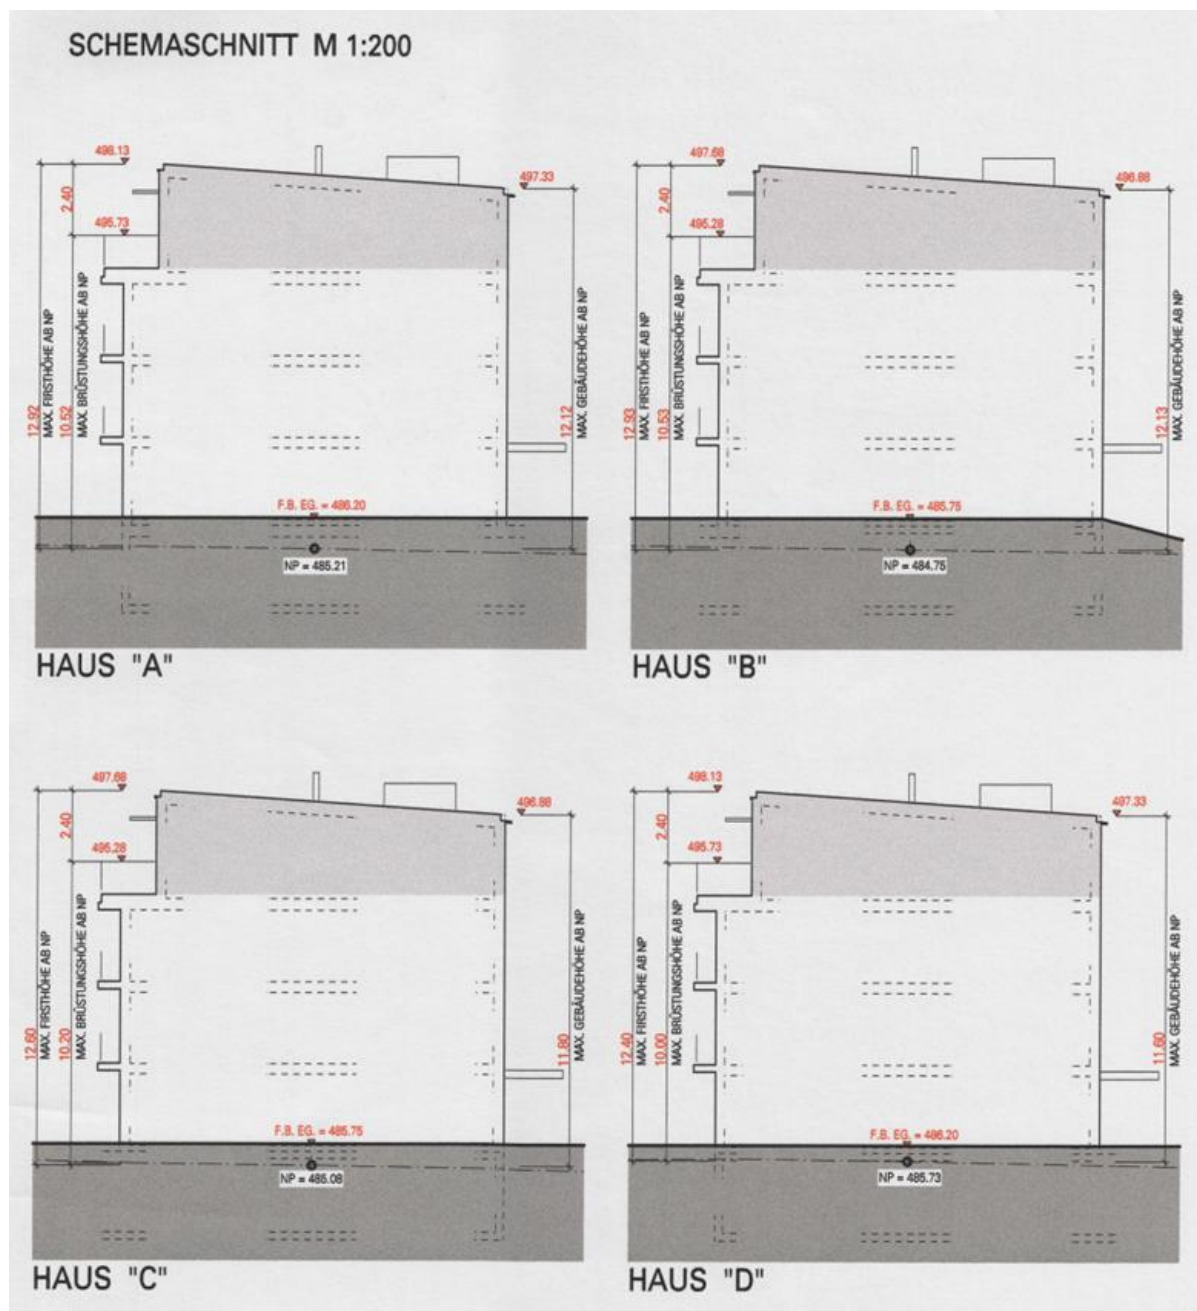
Änderung Schemaschnitt Überbauungsplan Grofenbrüel Wangs
